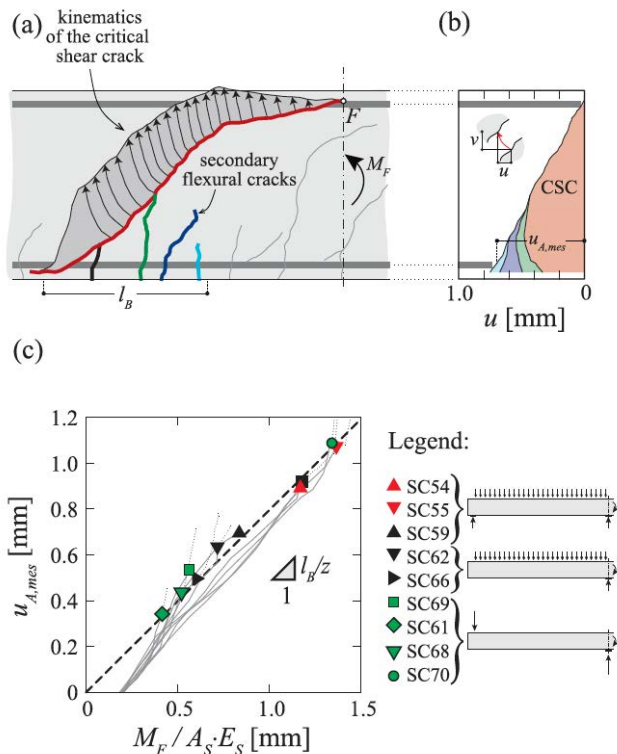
Mediciones de las cinemáticas de la fisura para el espécimen SC59 (figura adaptada de la referencia [24]): (a) geometría de la fisura y desplazamientos relativos medidos entre los labios de la fisura; (b) componente horizontal de la apertura de la fisura; y (c) componente horizontal de la apertura acumulada de fisura a la altura de la armadura, en función del momento aplicado para distintos especímenes.
